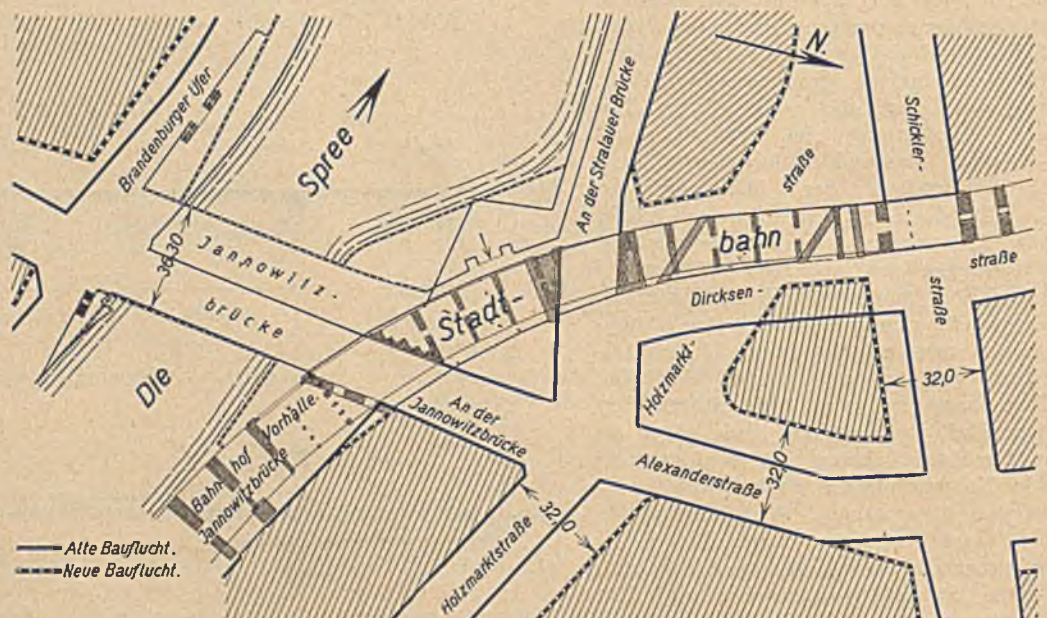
Umbau der Jannowitzbrücke Berlin und der Reichsbahnviadukte am Bahnhof „Jannowitzbrücke“. — Lageplan.
